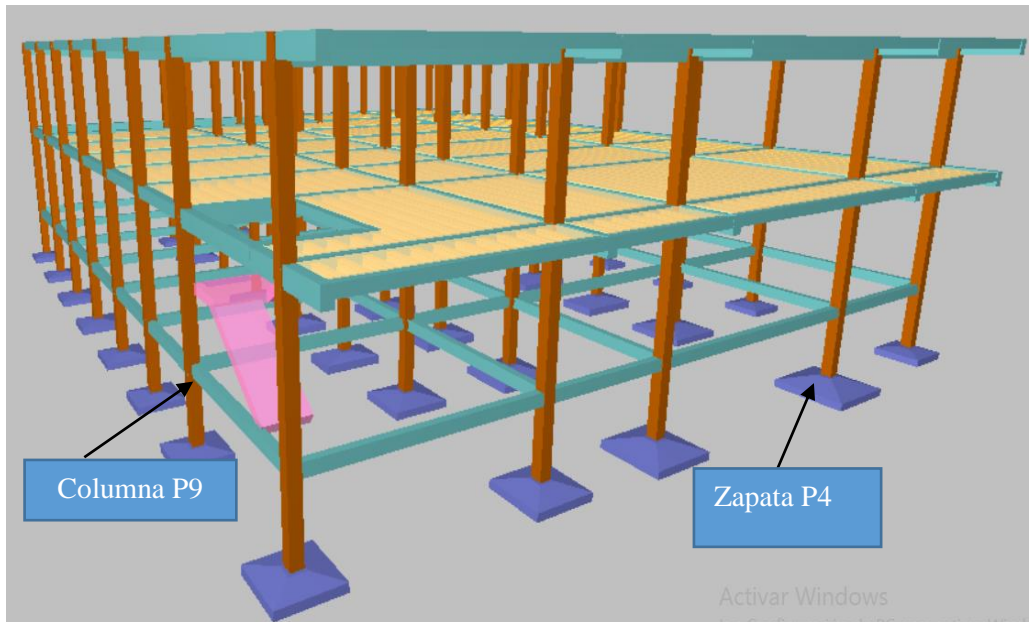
Columna más solicitada P9 a nivel planta baja
